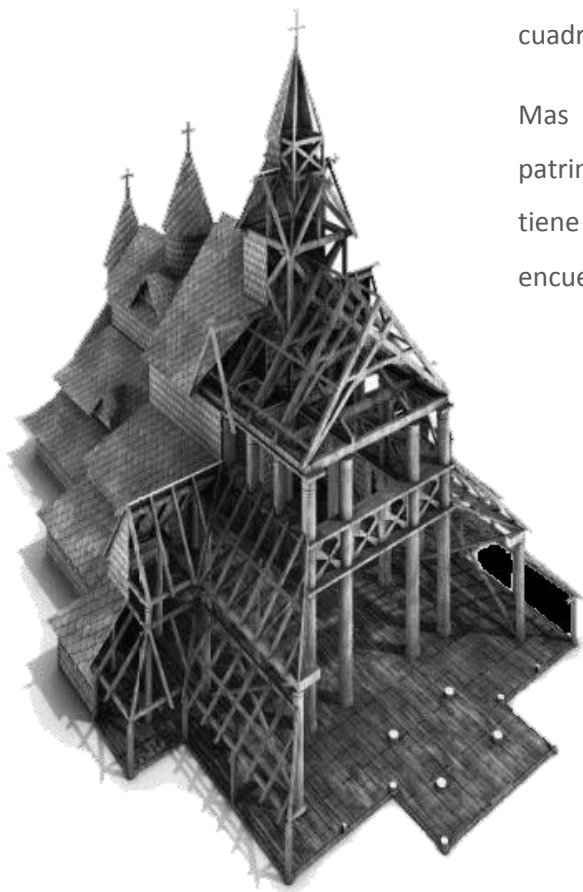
Modelo constructivo iglesias de Noruega Stavkirke
